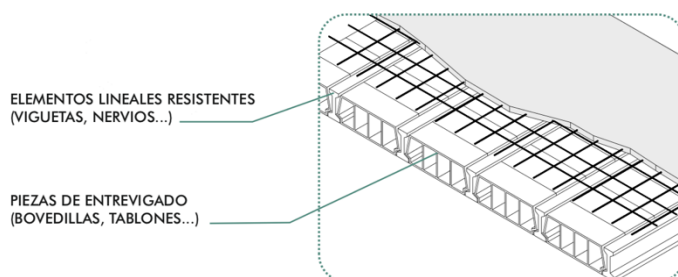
Detalle de forjado unidireccional [2]
